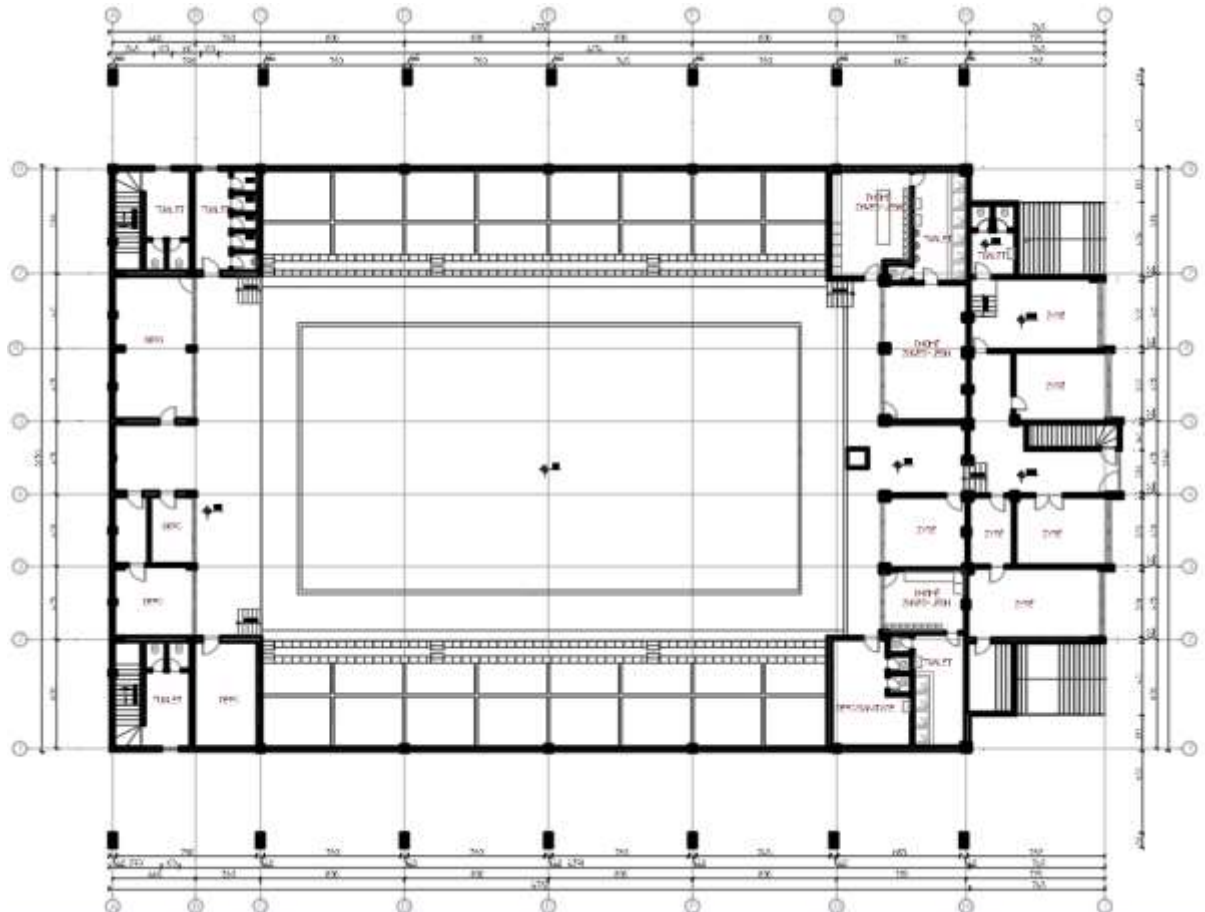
Planimetria e Pallatit të Sportit "Qazim Dervishi"
